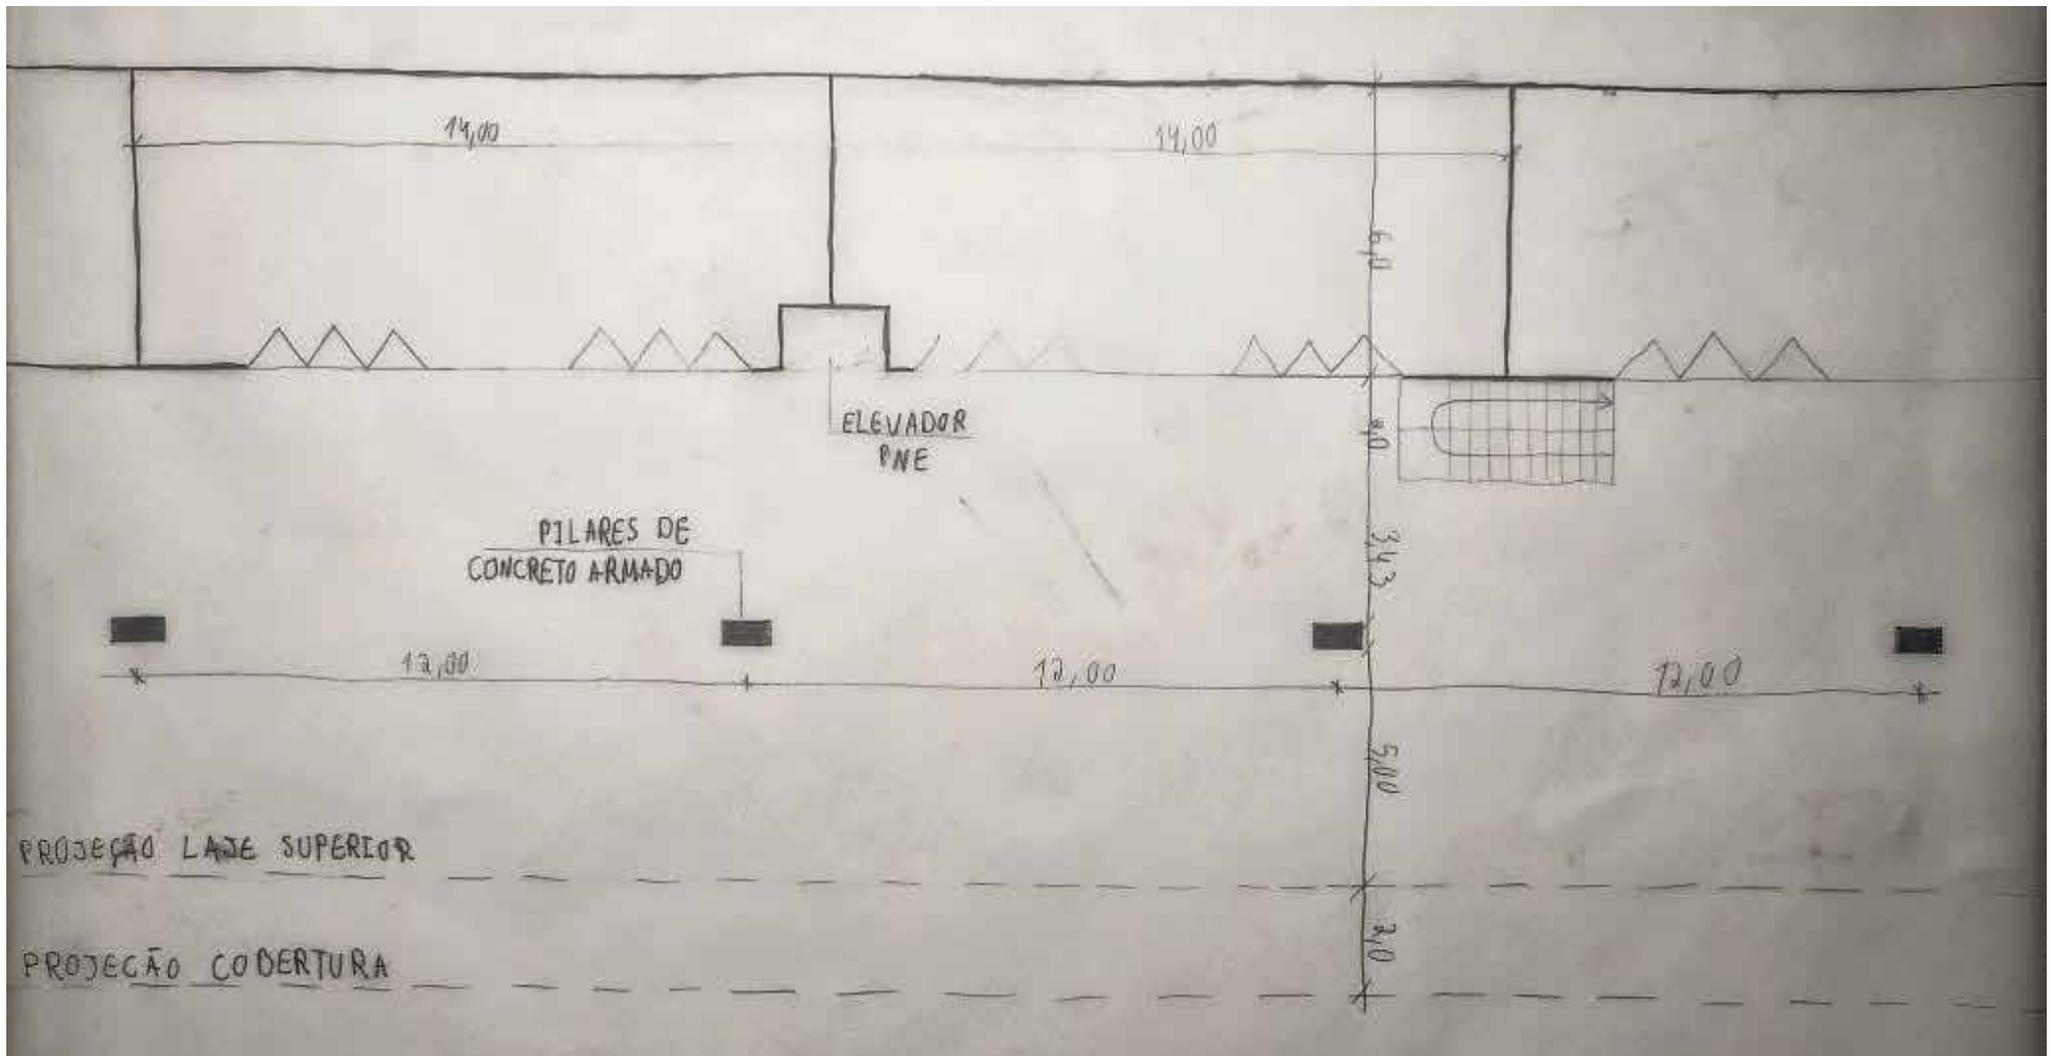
Croqui do pavimento térreo da faixa de restaurantes (sem considerar o espaço das cozinhas).
